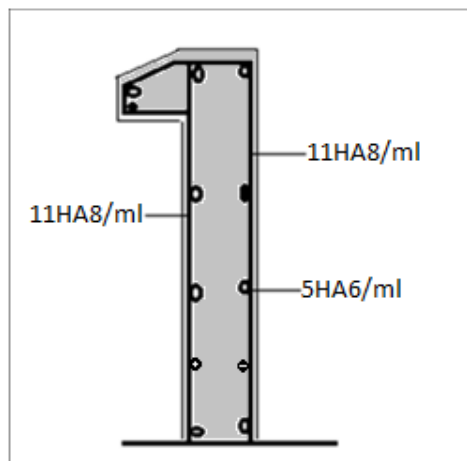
Schéma de ferrailage de type 01 de l'acrotère
